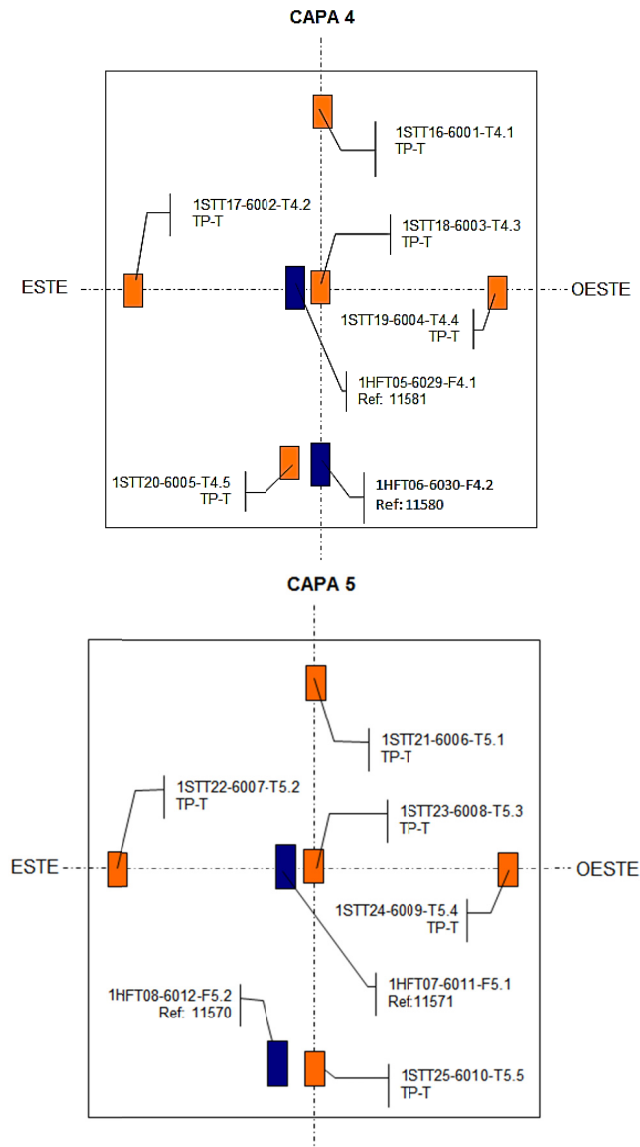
Instrumentación añadida al muro base con aislamiento
